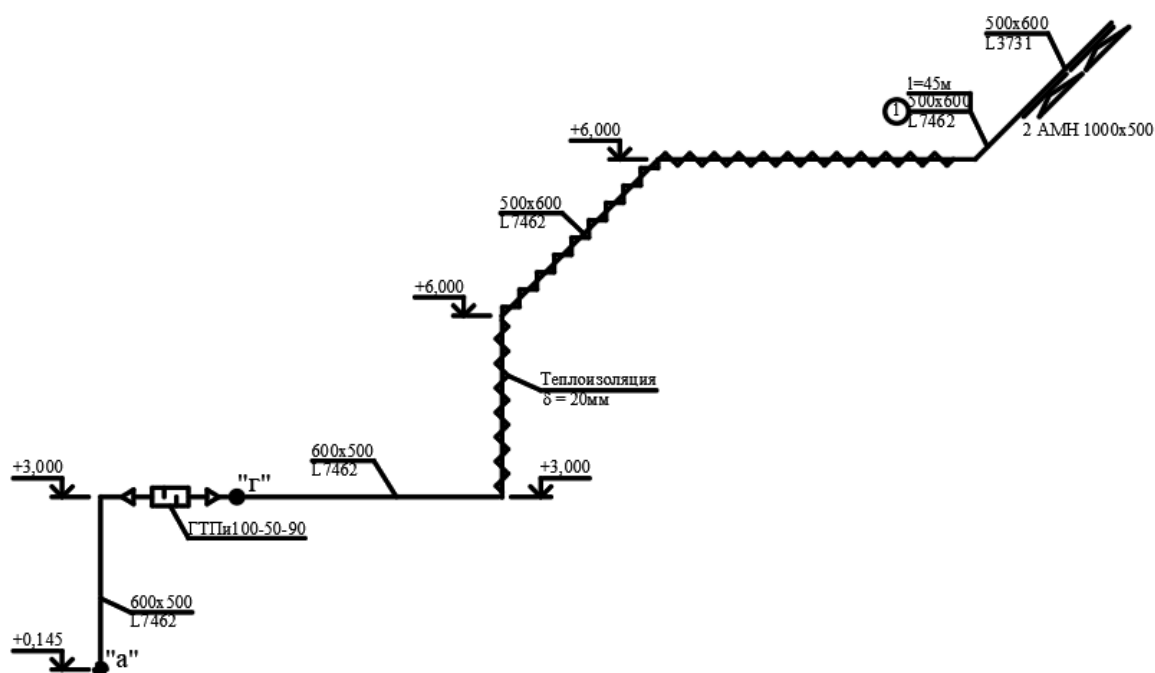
Расчетная схема вытяжной вентиляционной системы В1.
